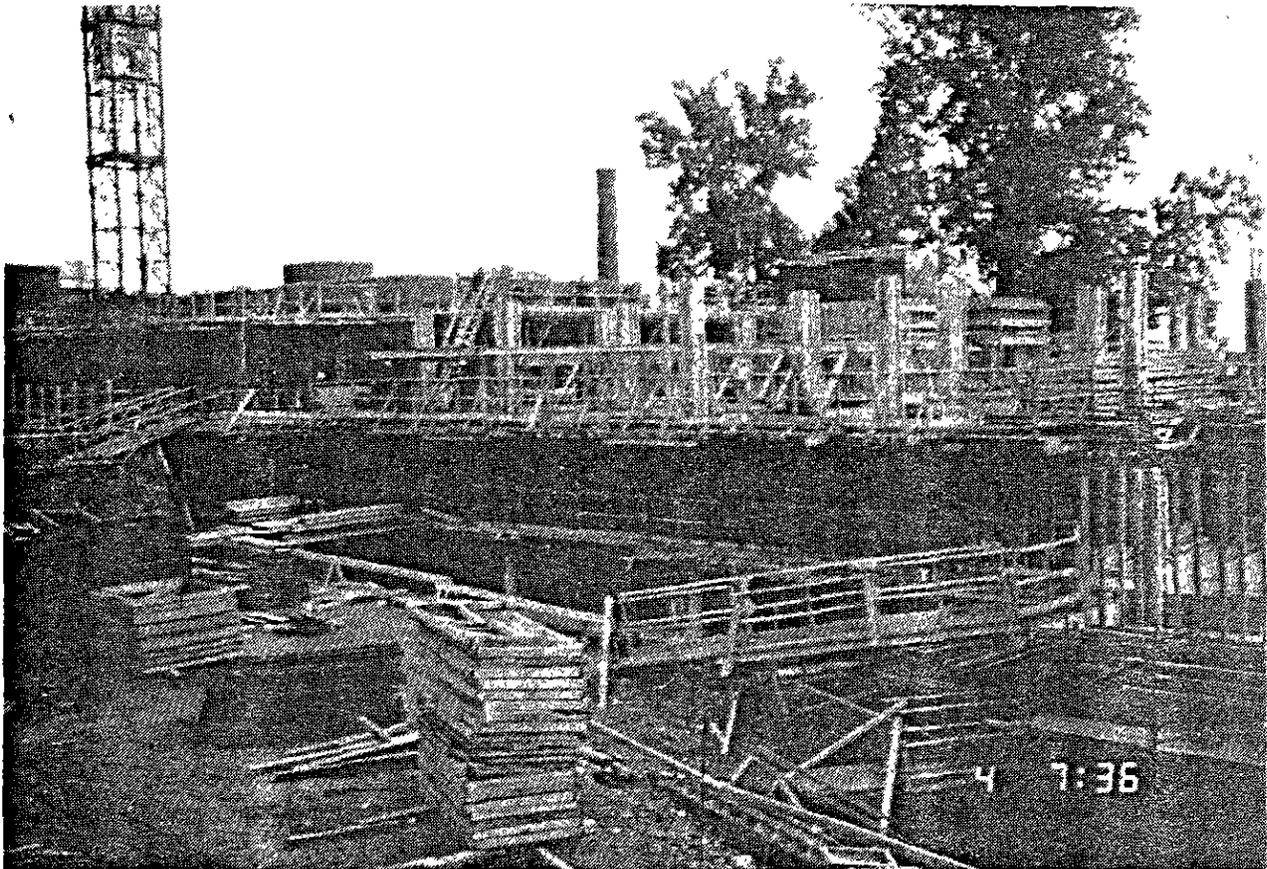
VUE GÉNÉRALE D'UN CHANTIER
